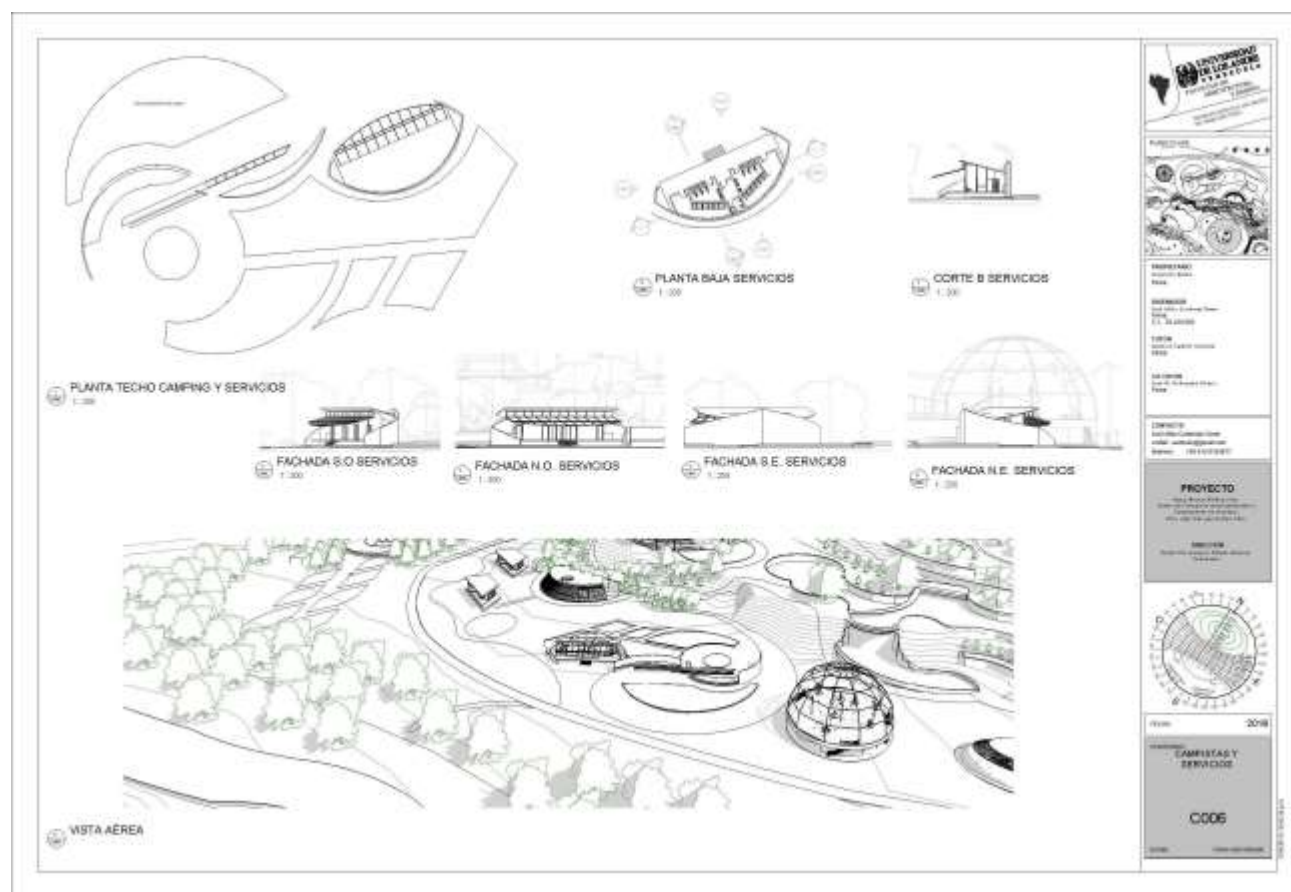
Planos y vistas de área de campamento, parrilleras y servicios.
